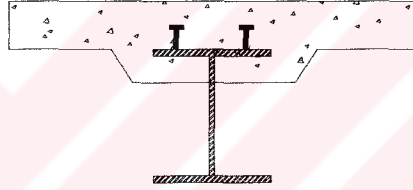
'de gösterilen karma kiriş, uygulamada en çok kullanılan tiplerden biridir. Çelik kiriş ve üzerindeki beton tabla, orta düzleme göre simetriktir. Bu tür kirişlerin projelendirilmesi ve inşası da diğerlerine göre hızlıdır. Karma kirişlerde, beton ile çeliğin birlikte çalışmasında gerekli aderansın sağlanması için çeşitli şekillerde kayma bağlantıları
